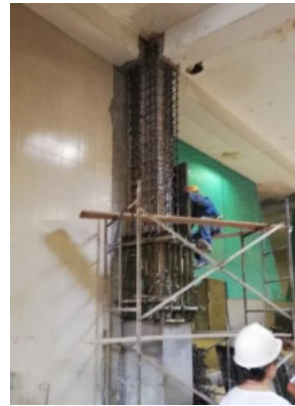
Labores de reforzamiento estructural realizado a las columnas existentes.
